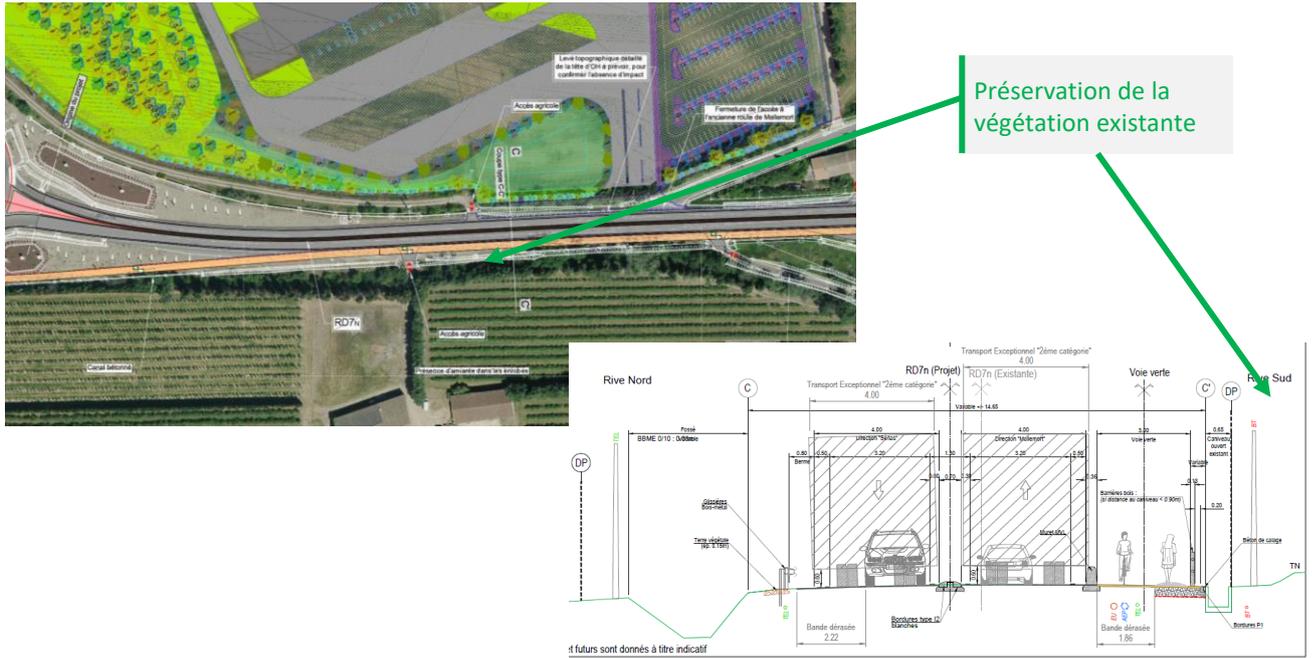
PLAN D'AMENAGEMENT (PLANCHE 2/3) / PROFIL EN TRAVERS TYPE
